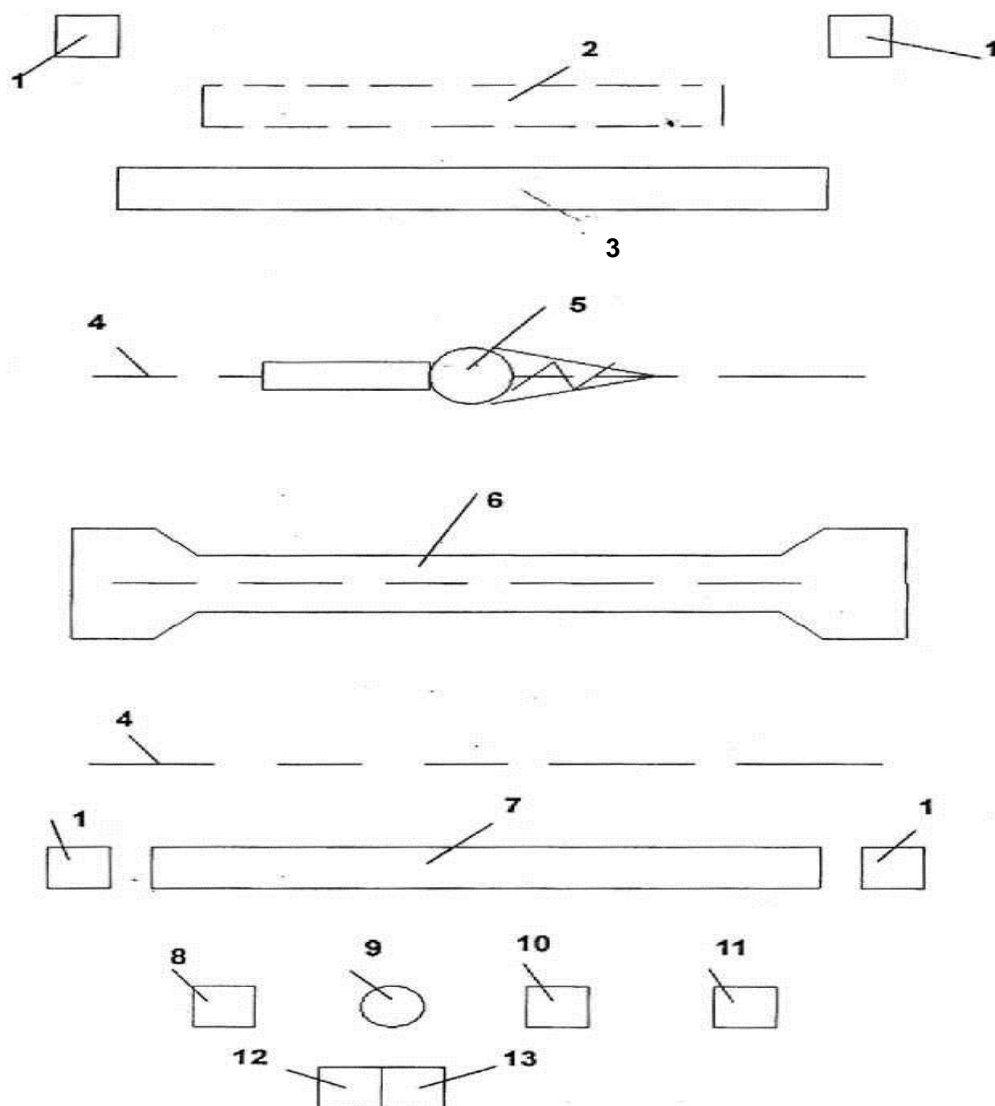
Схема монтажной площадки трубы: 1 – склад блоков оголовков, 2 – склад фундаментов, 3 – склад лекальных блоков, 4 – путь движения крана, 5 – кран, 6 – контур трубы, 7 – склад звеньев трубы, 8 – емкость с цементом, 9 – бетономешалка, 10 – емкость с водой, 11 – электростанция, 12 – склад щебня, 13 – склад песка
